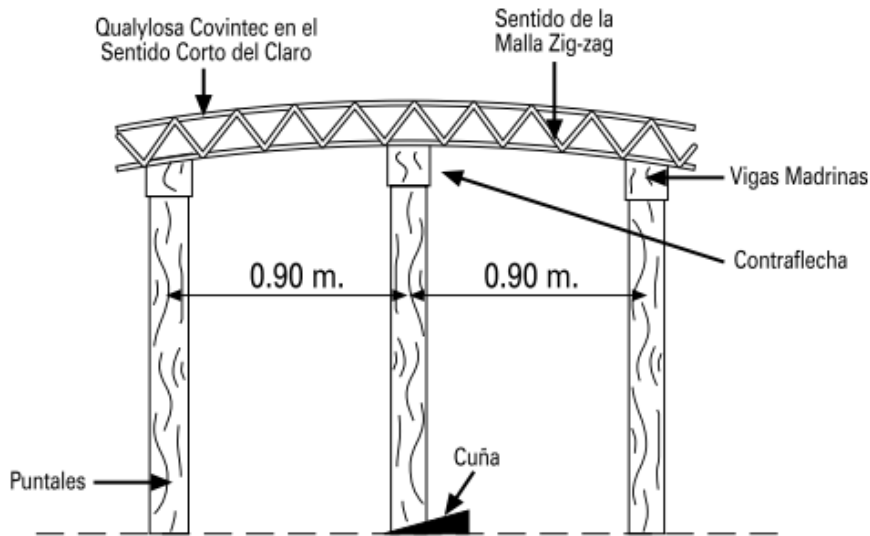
Madrinas y puntales (Corte longitudinal).
